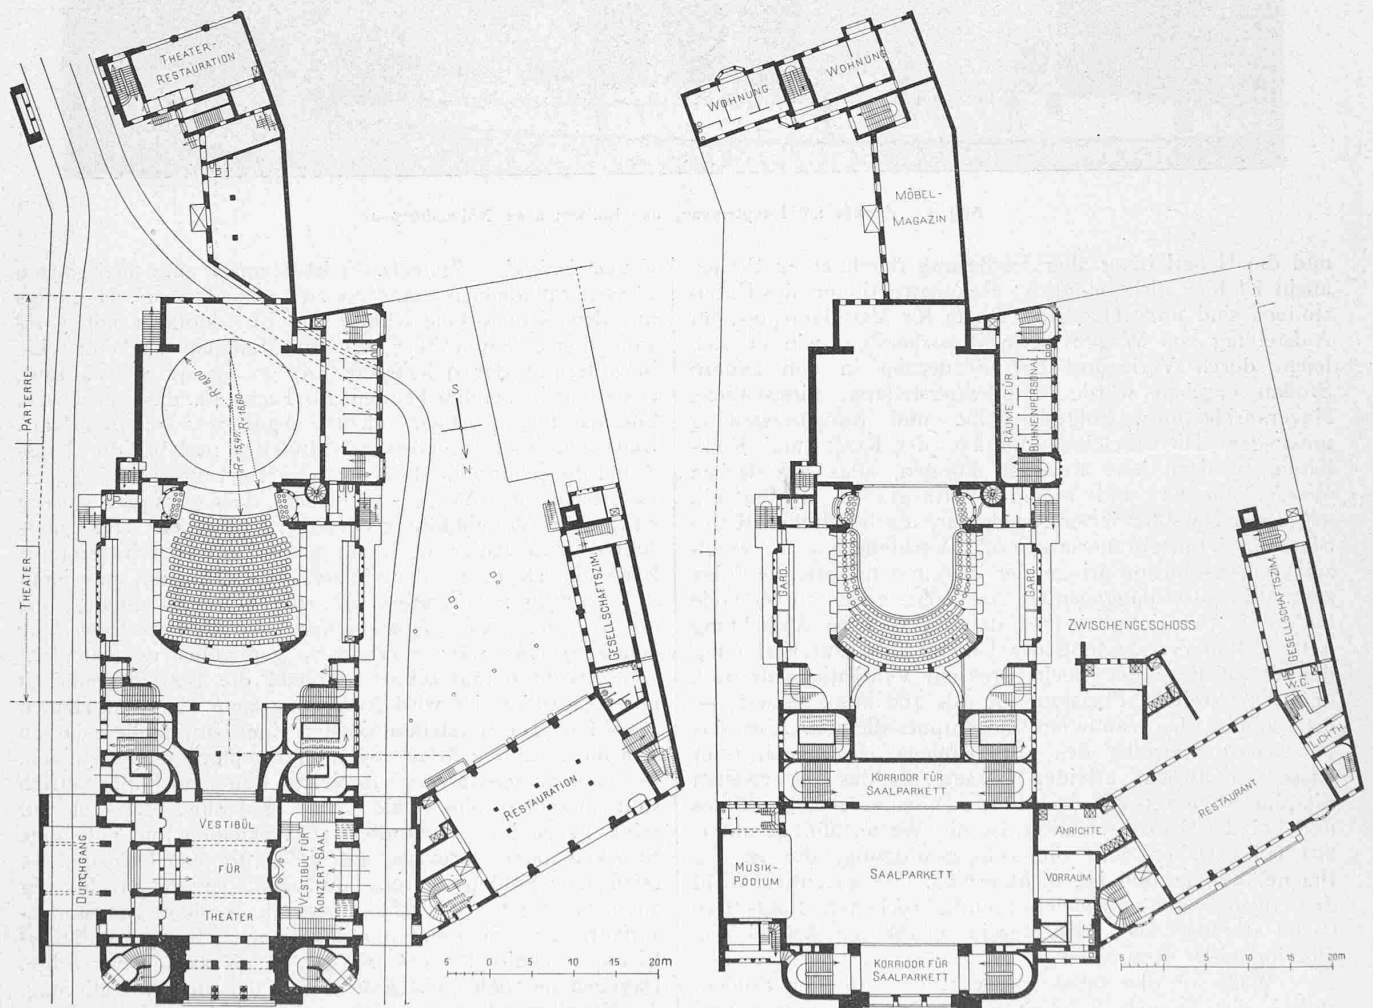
Grundriss vom Erdgeschoss bzw. Theaterparterre.
